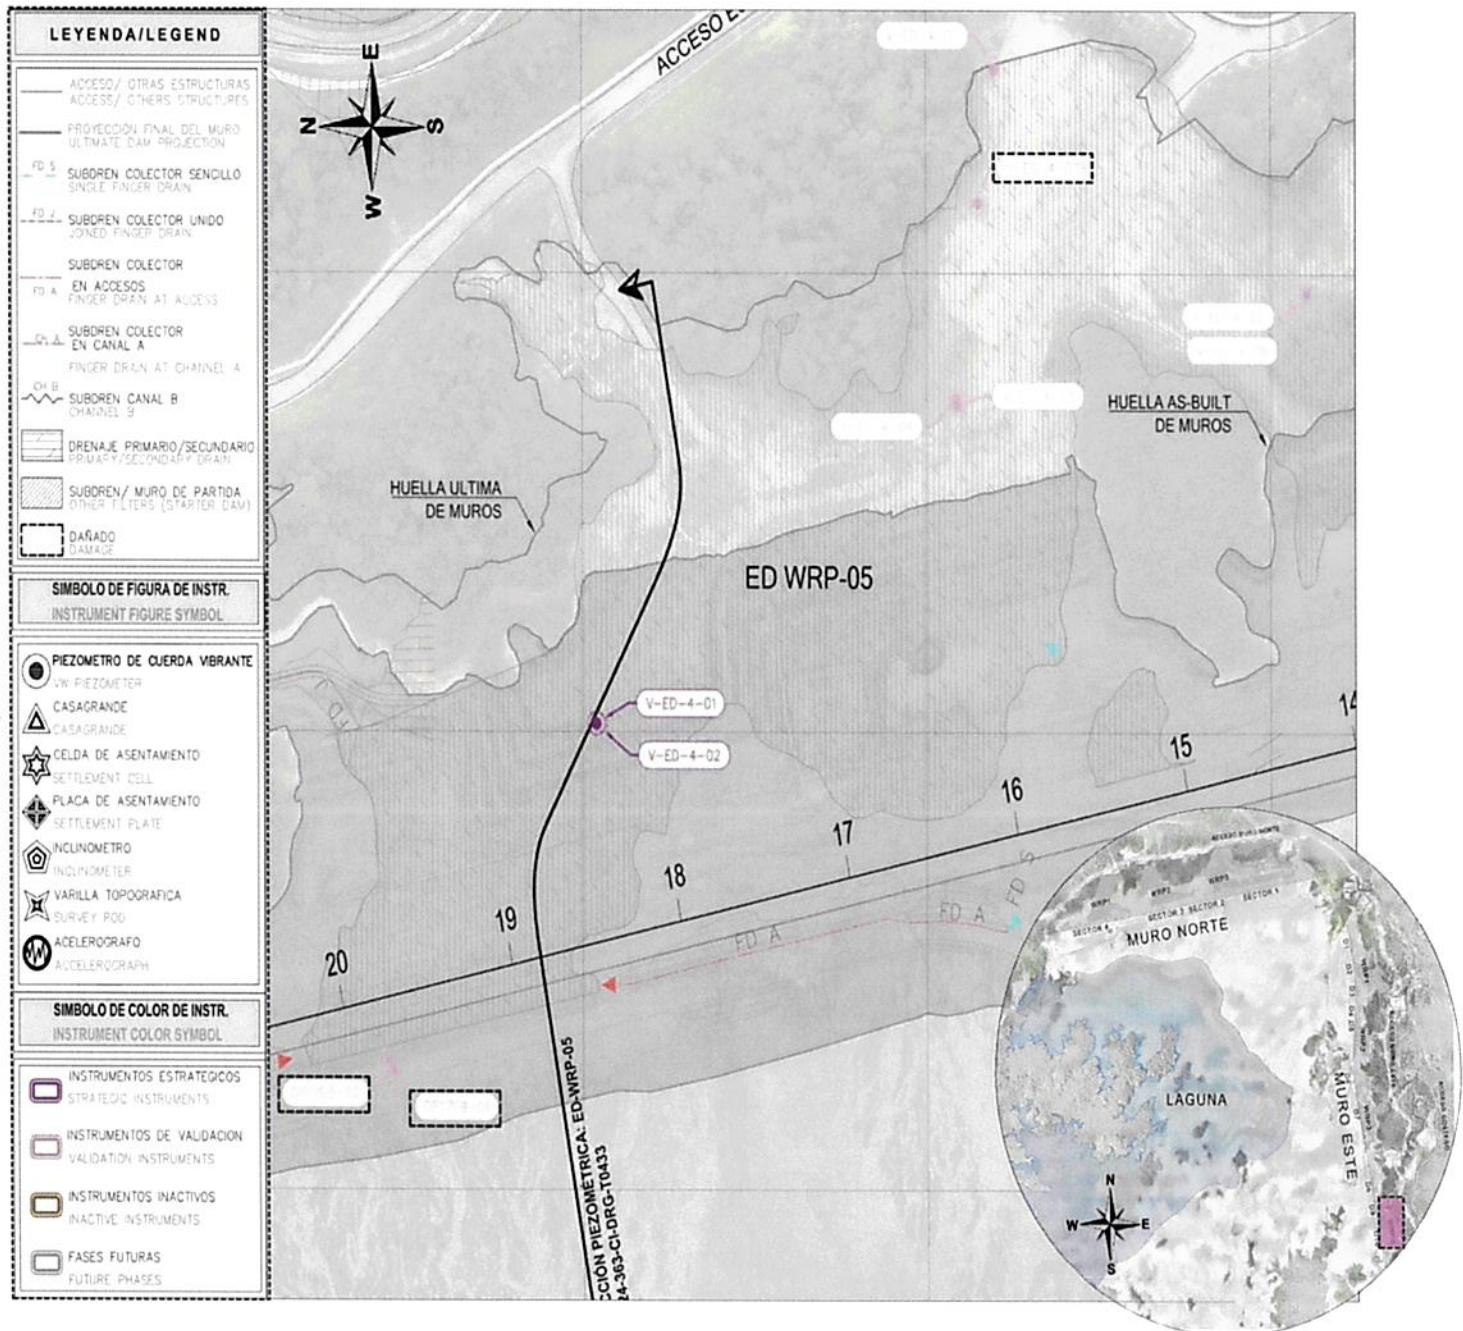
Vista de Planta en el Muro Este WRP5 con Piezómetros
